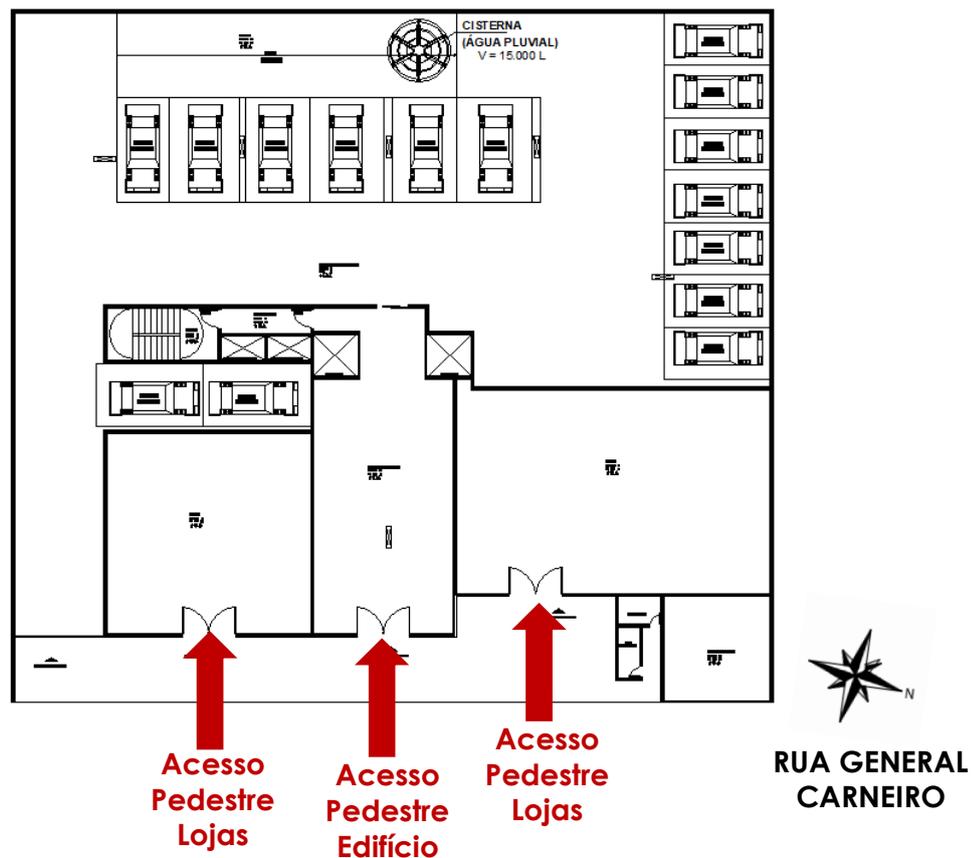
Planta Baixa Pavimento Térreo - Acesso de pedestres
